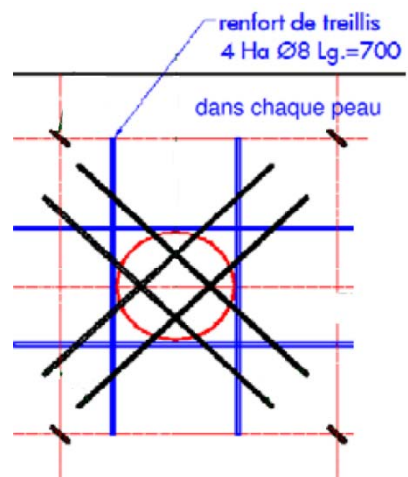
Principe de renforcement du ferrailage au droit des cylindres MVA de diamètre ≥ 127 mm :
